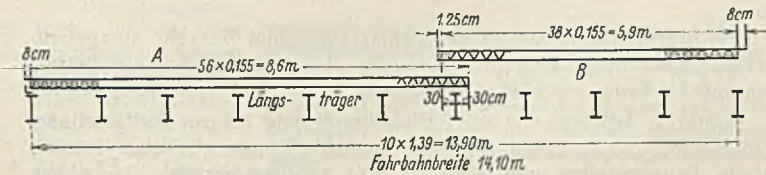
Verlegungsplan für die Bewehrungsträger im aufgehängten Brückenteil.
